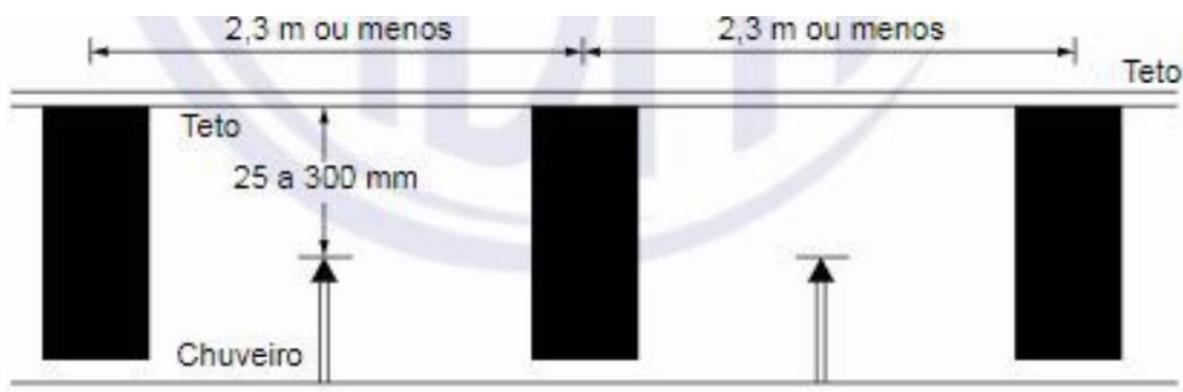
Posicionamento de chuveiro automático em pé de cobertura-padrão ou de cobertura estendida, sob teto obstruído
